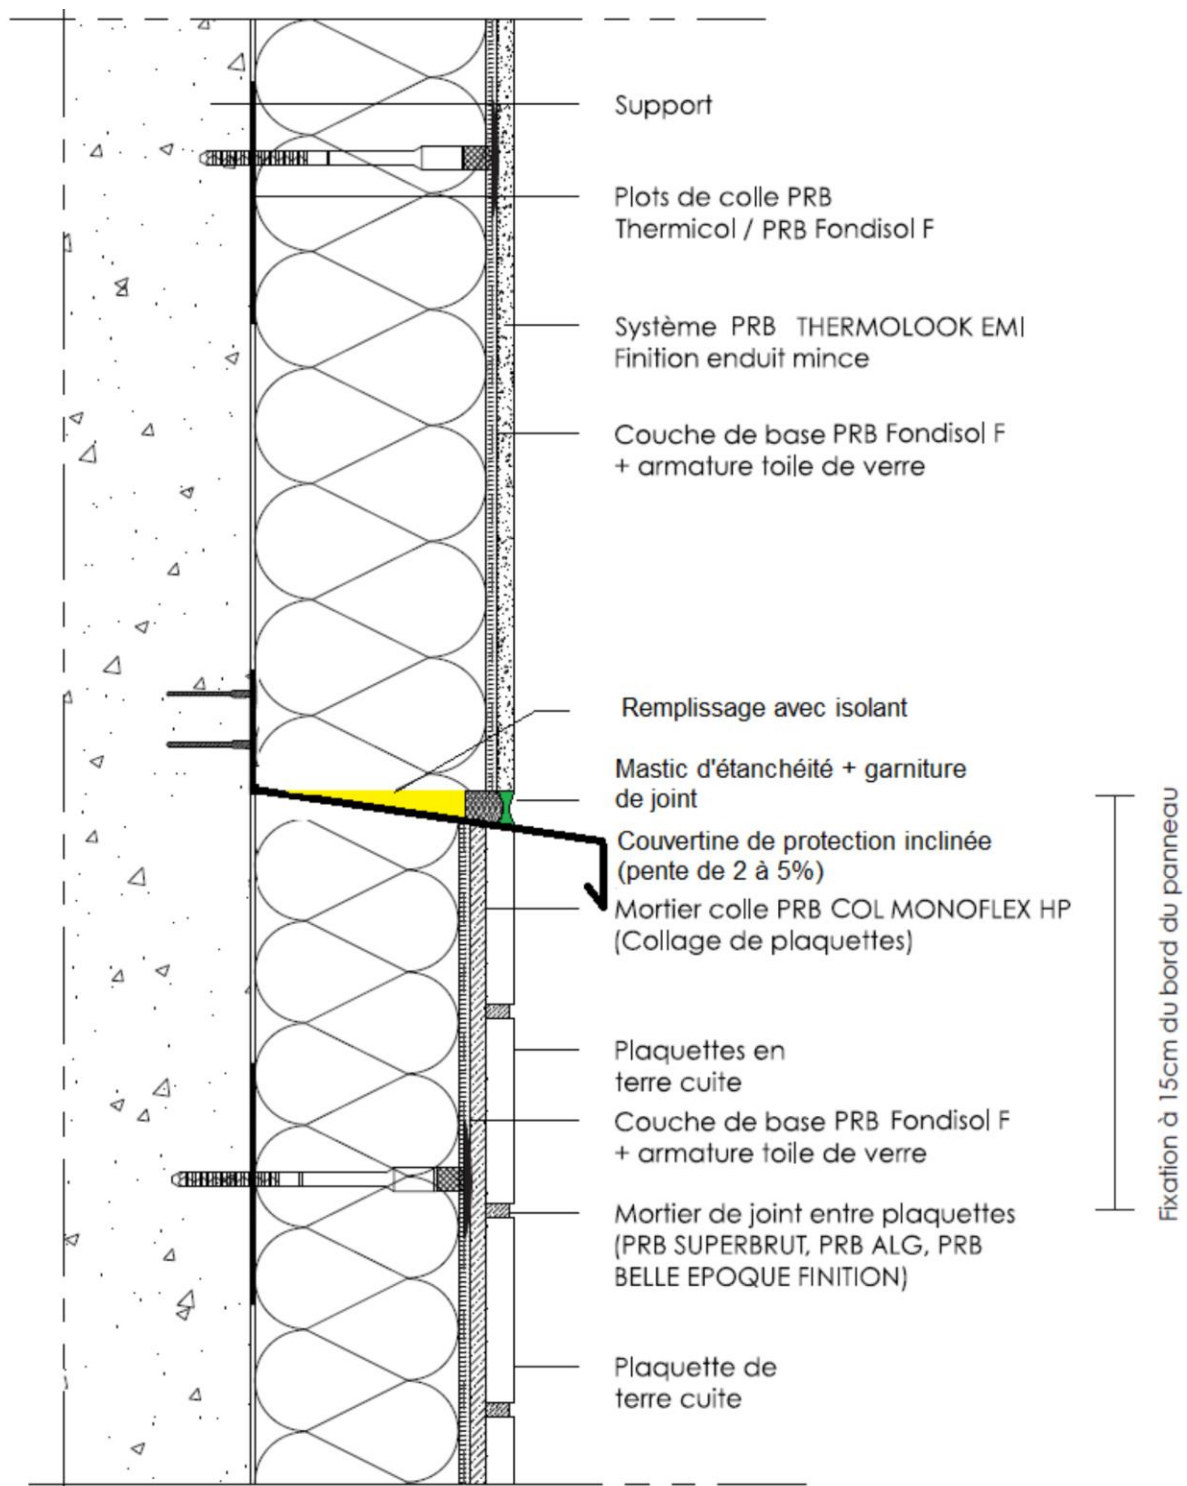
Finition plaquettes de parement en terre cuite : raccordement avec un système d'enduit sur isolant avec utilisation d'une bavette
